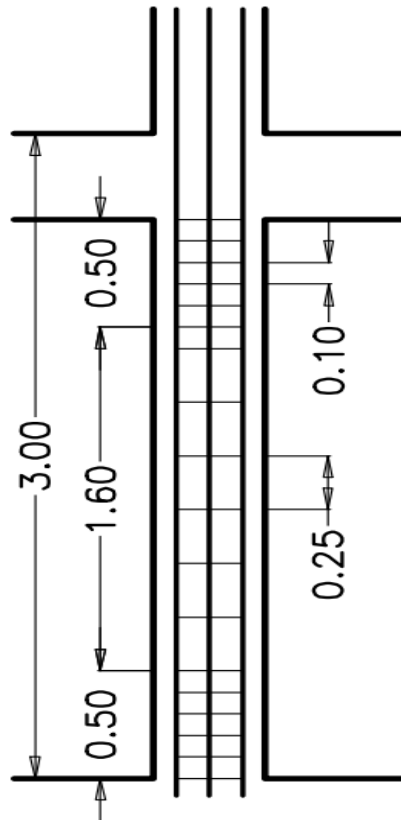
Distribución de acero longitudinal Columna 40x40cm
